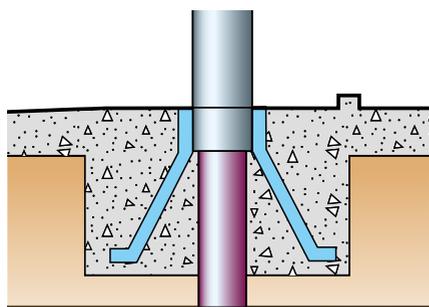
Piédestal de pompe solidement fixé au bloc de fondation
